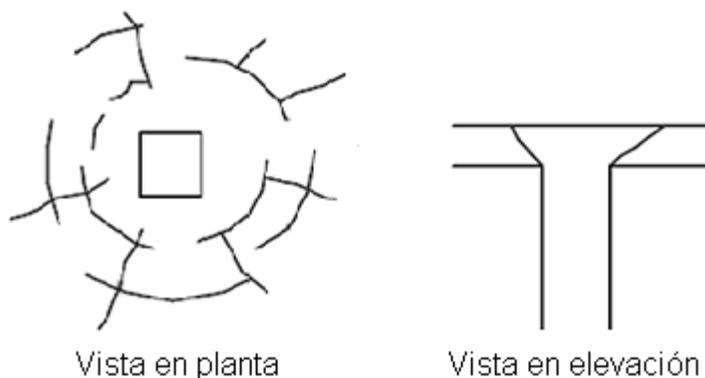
Fisuras por punzonamiento en unión losa columna (Pérez, 1994).
